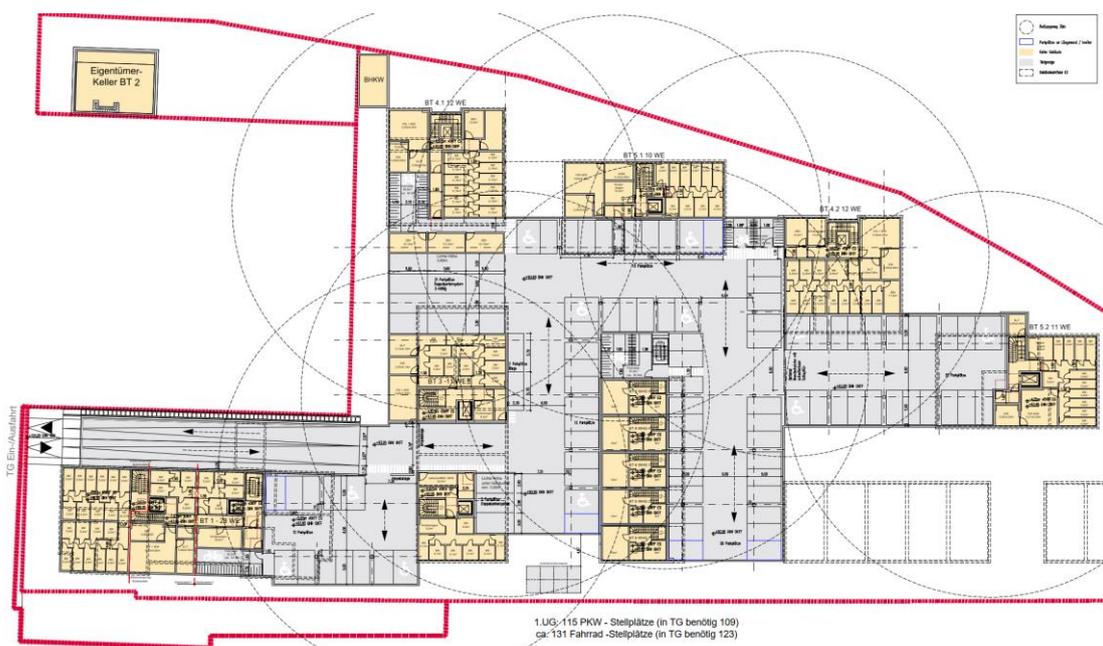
Grundriss der geplanten Tiefgarage der Wohnbebauung Ludwigsgarten (ASP 2020)
